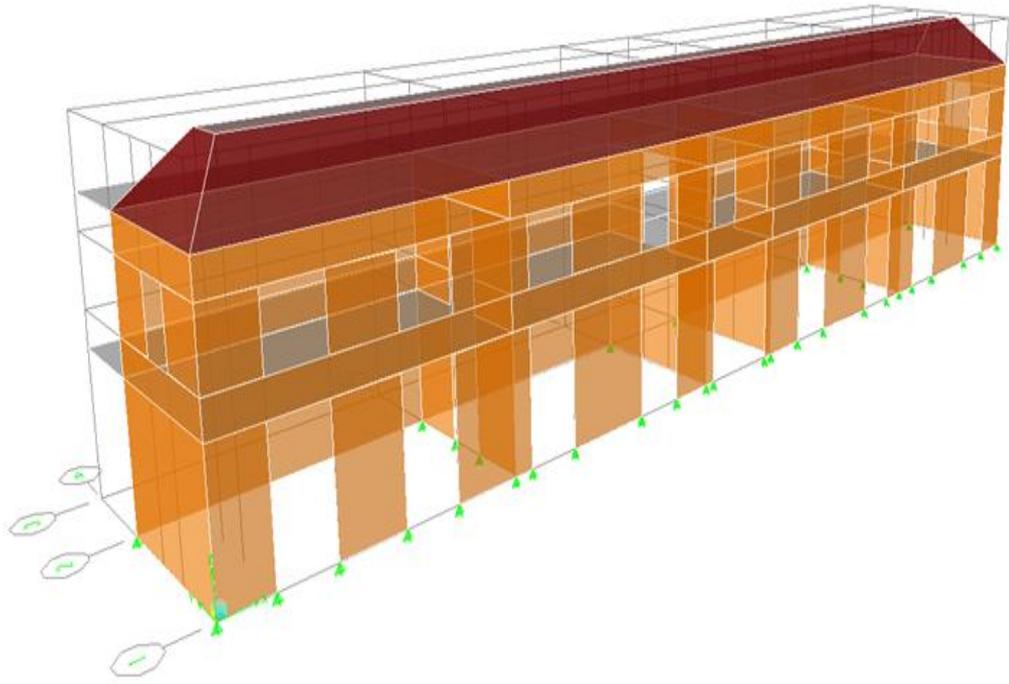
Geometría del Modelo de Muros y Cobertura.
